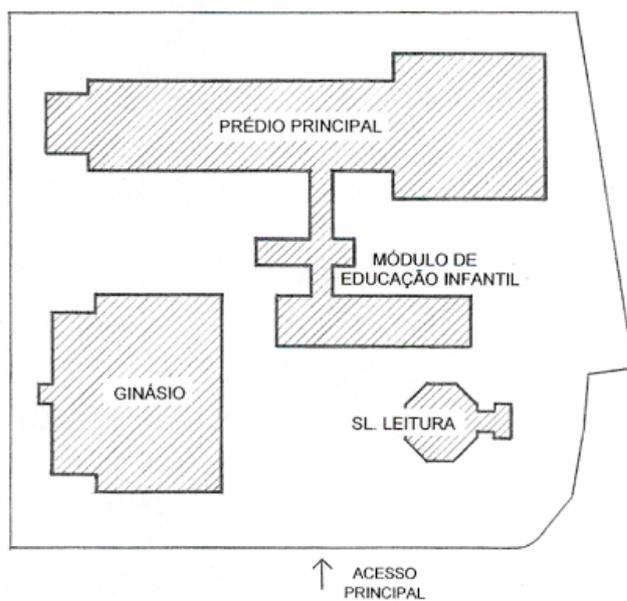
CIEP Yuri Gagarin - Planta de Situação Esquemática
